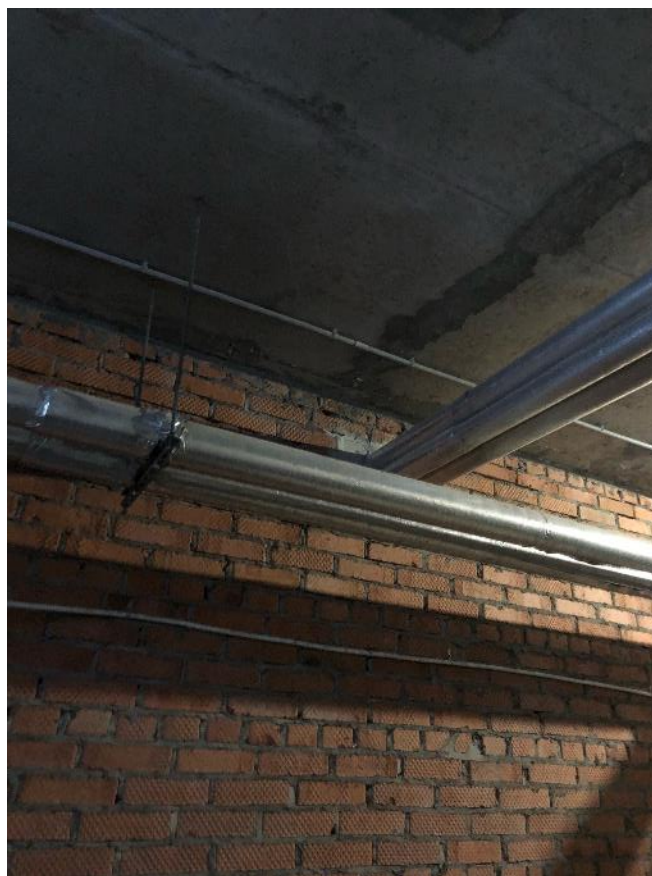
Общий вид узла примыкания стены к плите перекрытия
